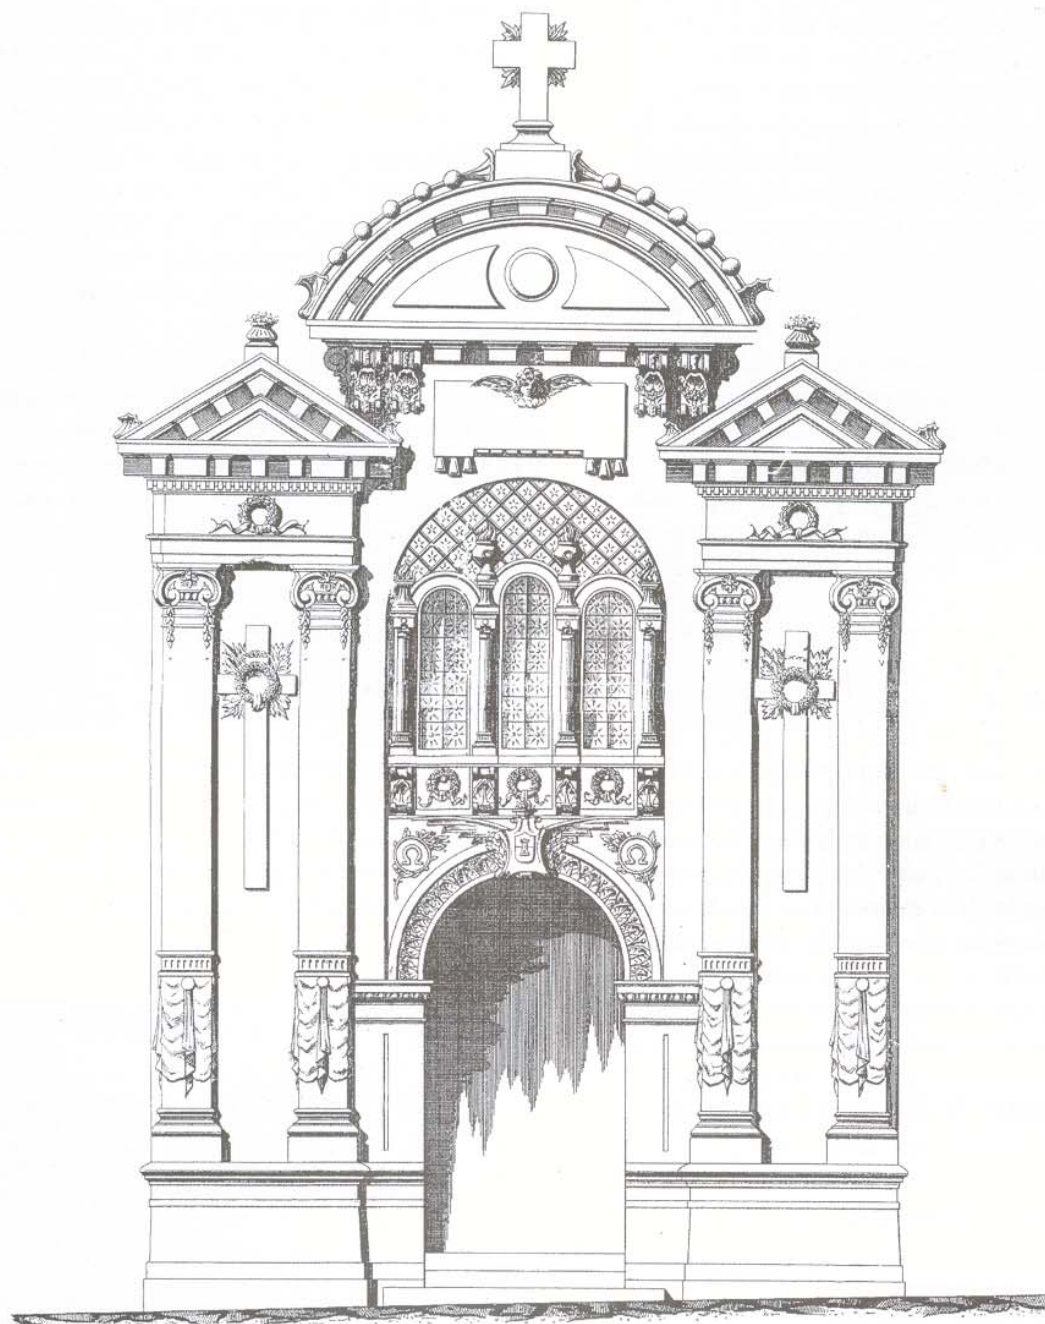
Alzado del proyecto para capilla del cementerio de San Clemente. Pedro Cerdán. 1920
